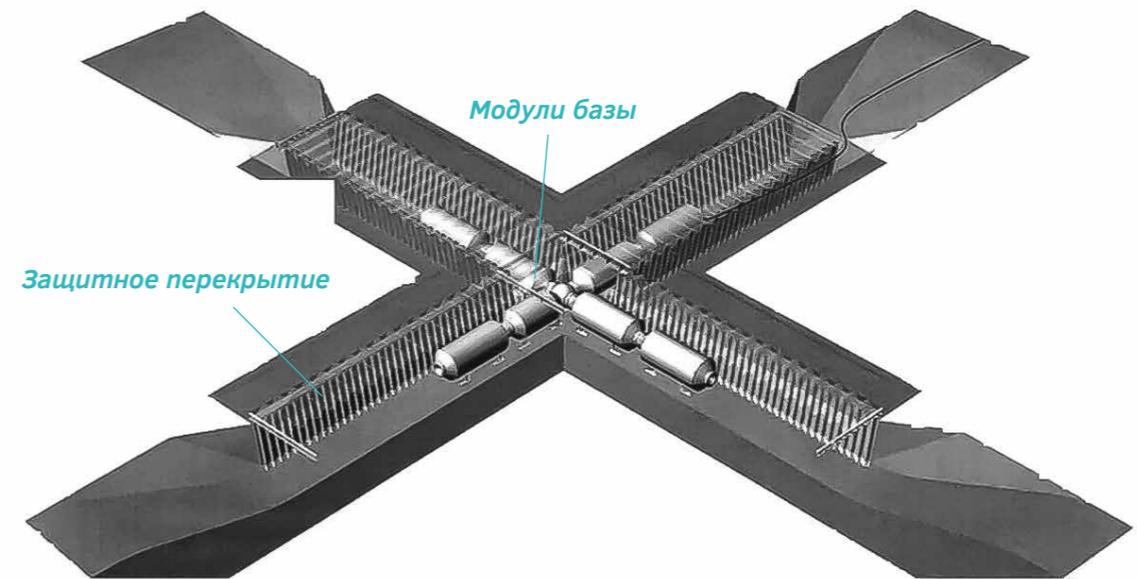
Лунная база, размещенная в траншее с перекрытием и засыпкой реголитом (2008 г.)
